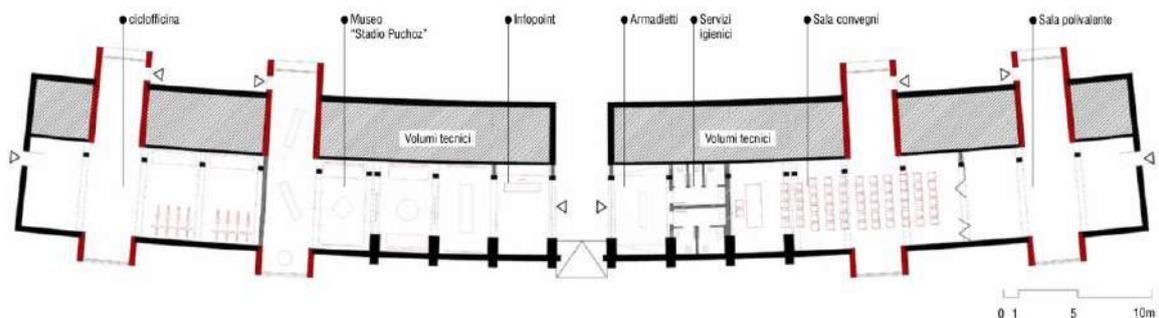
Planimetria Tribune – Arch. Roberto Rosset
